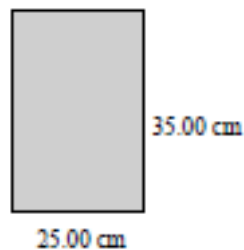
SECCIÓN DE LA VIGA TRANSVERSAL
